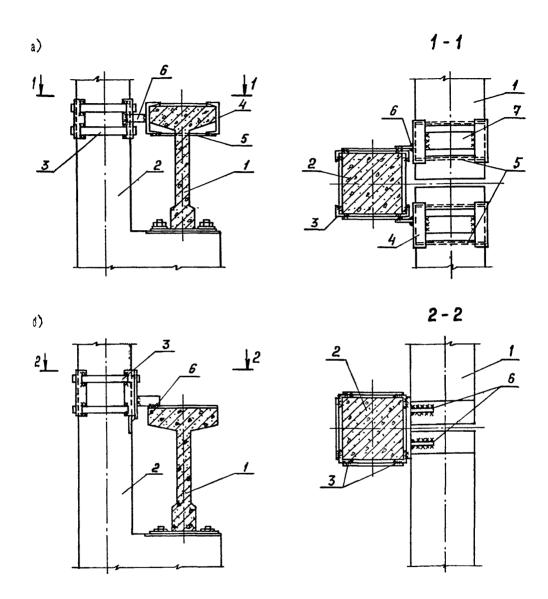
Усиление крепления подкрановой балки к колонне
